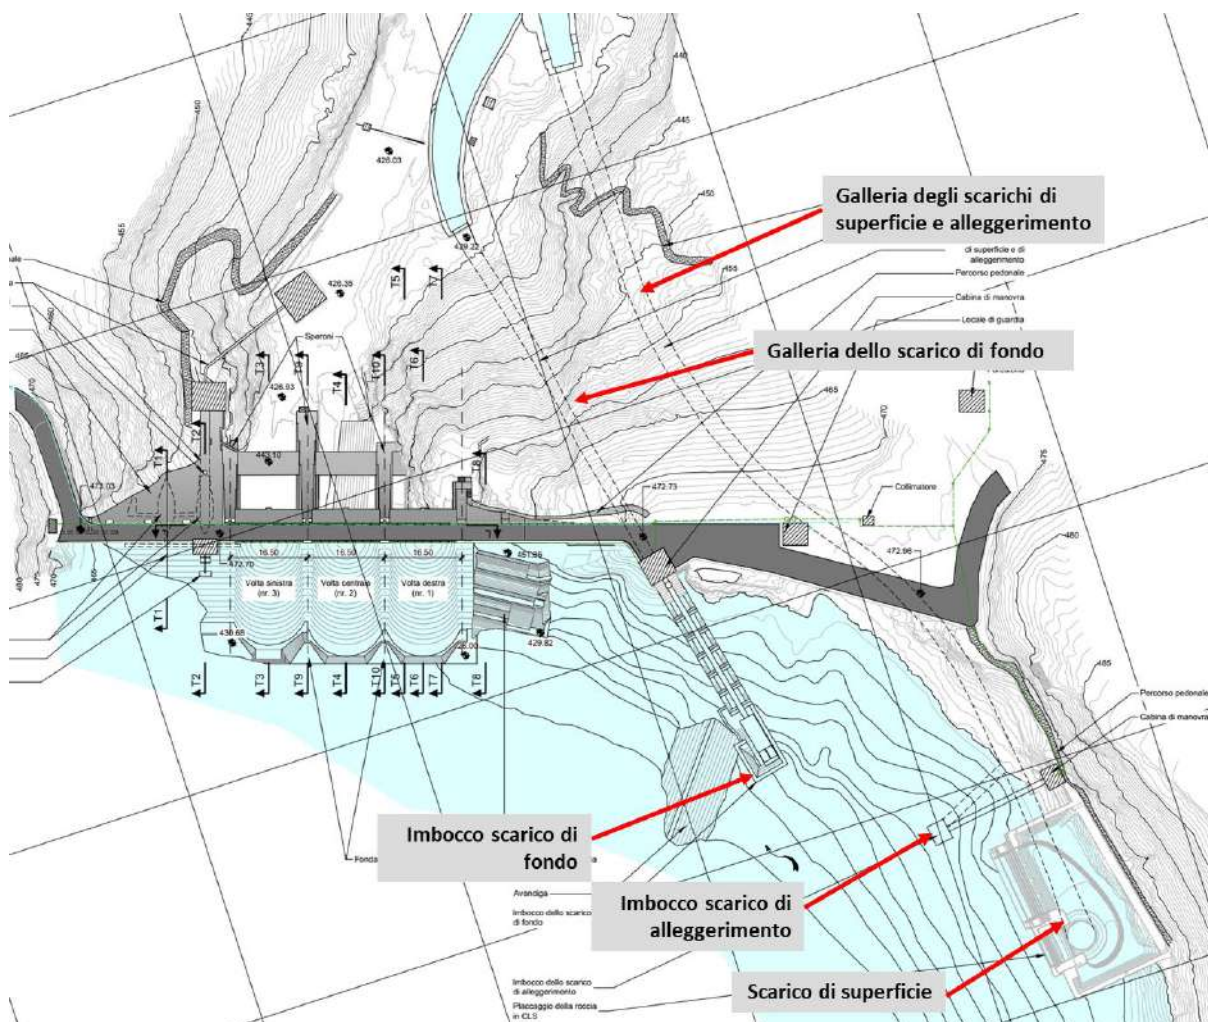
Stralcio planimetrico della diga allo stato attuale
